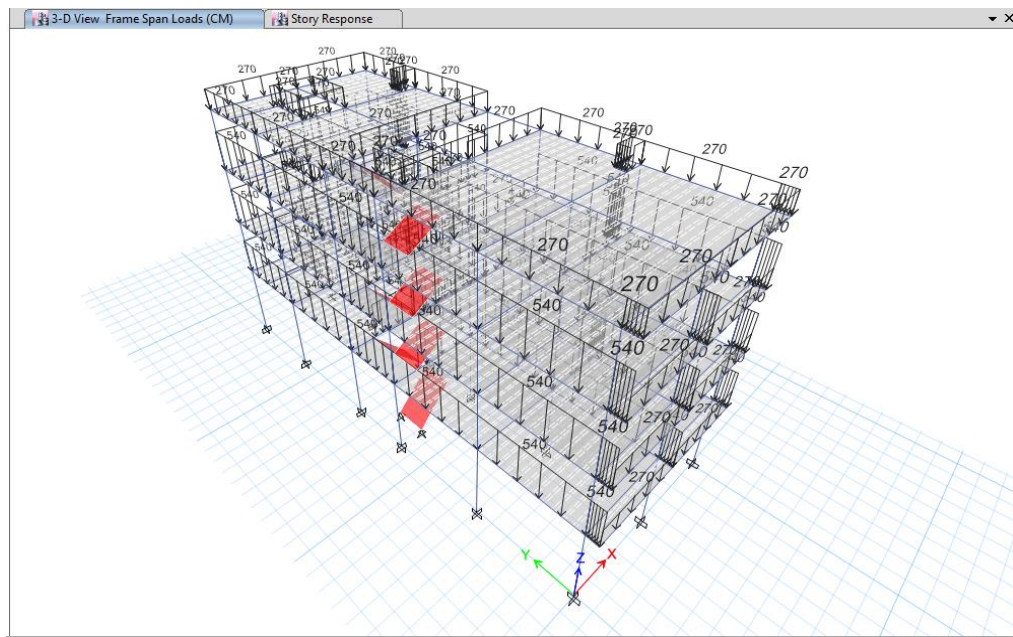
Carga distribuida en vigas por tabiquería en unidad tonf.
